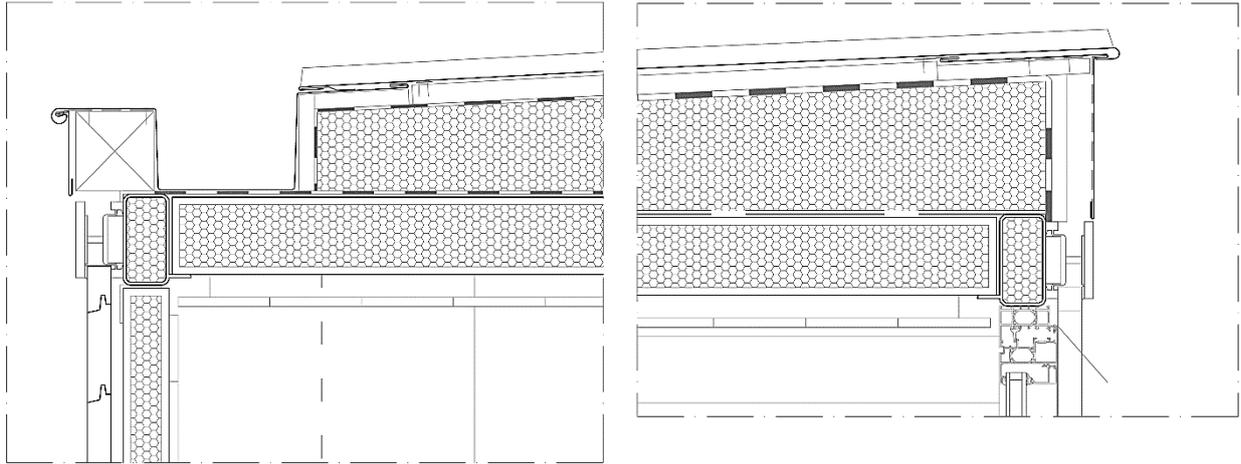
Studio di integrazione del progetto di sopraelevazione alla facciata dell'edificio esistente
